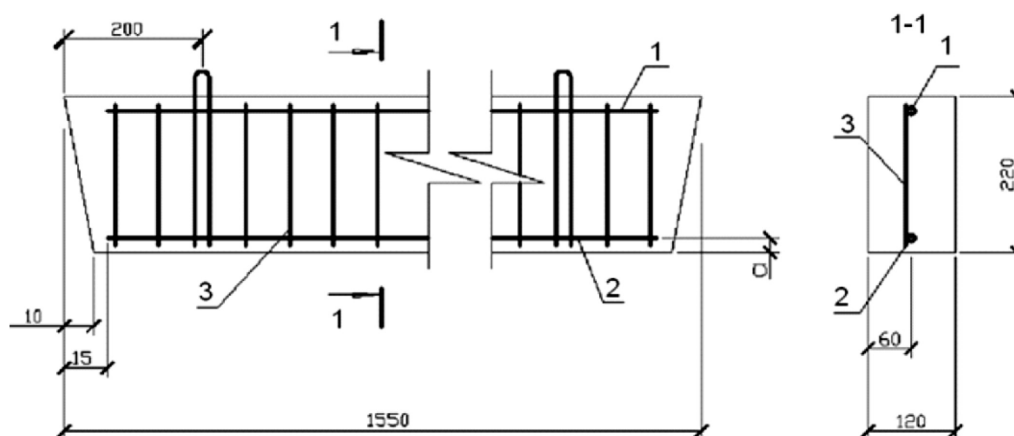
Перемычка ЗПБ16-37-п с традиционным армированием:
